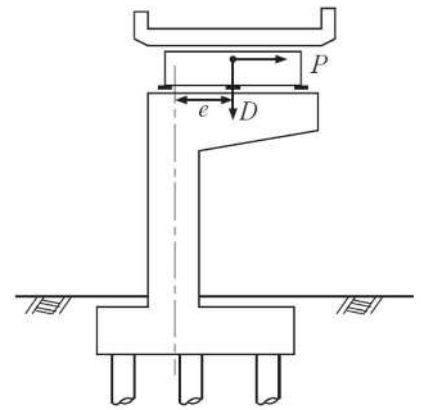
上部構造等の死荷重による偏心モーメントが作用する橋脚の例 (道示V図-解 8.8.1)
